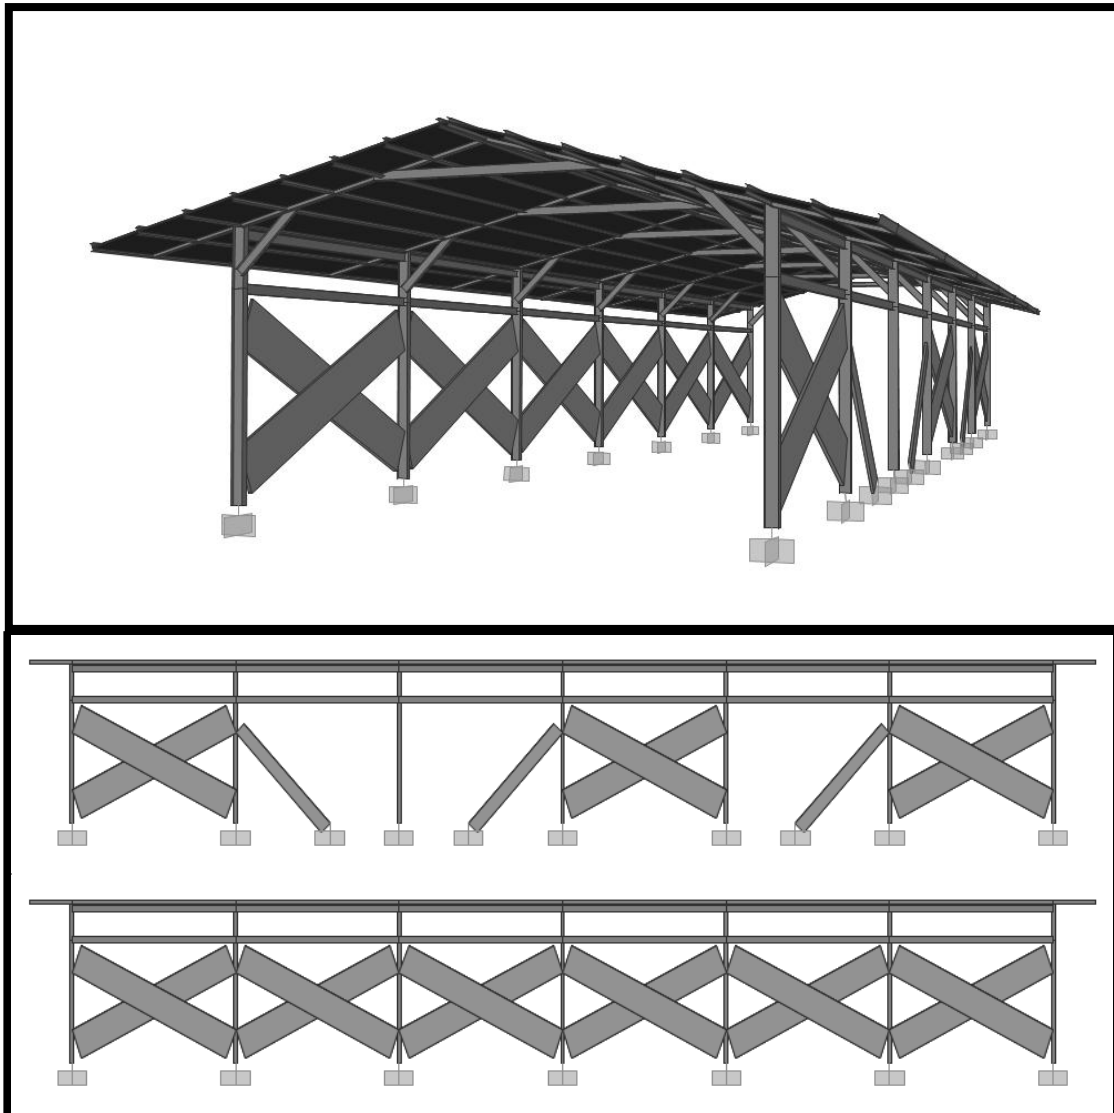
Pórticos y Perfiles de los Miembros de los Modelos de las Escuelas Tipo R Tradicional Reforzada (R-3).
